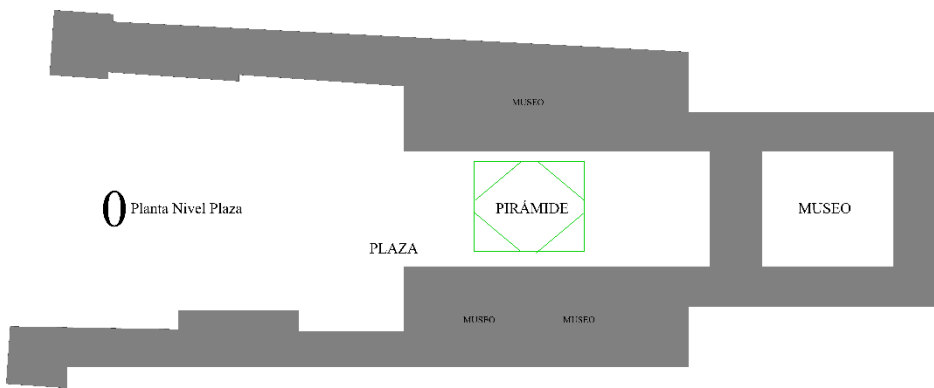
Planta Nivel 0 Plaza - Elaboración Propia
